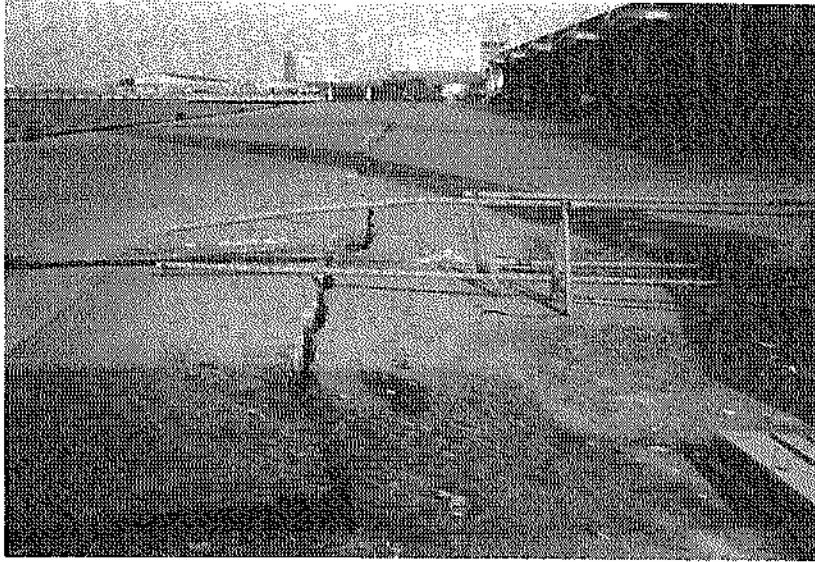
エプロン被災状況 (第2埠頭地区, ⑥西側岸壁(-9.0m))
